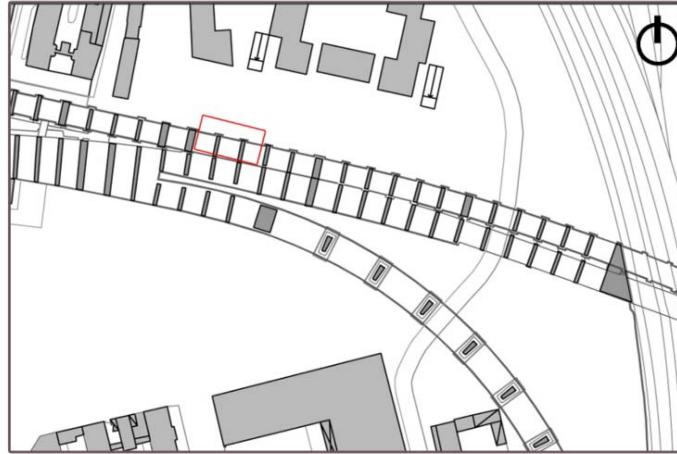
Stralcio planimetrico con riferimento alle fondazioni considerate. Fonte: elaborazione grafica dell'autore
